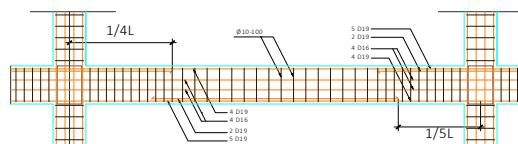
Detail tulangan balok lantai 5 ( balok type 2 )
